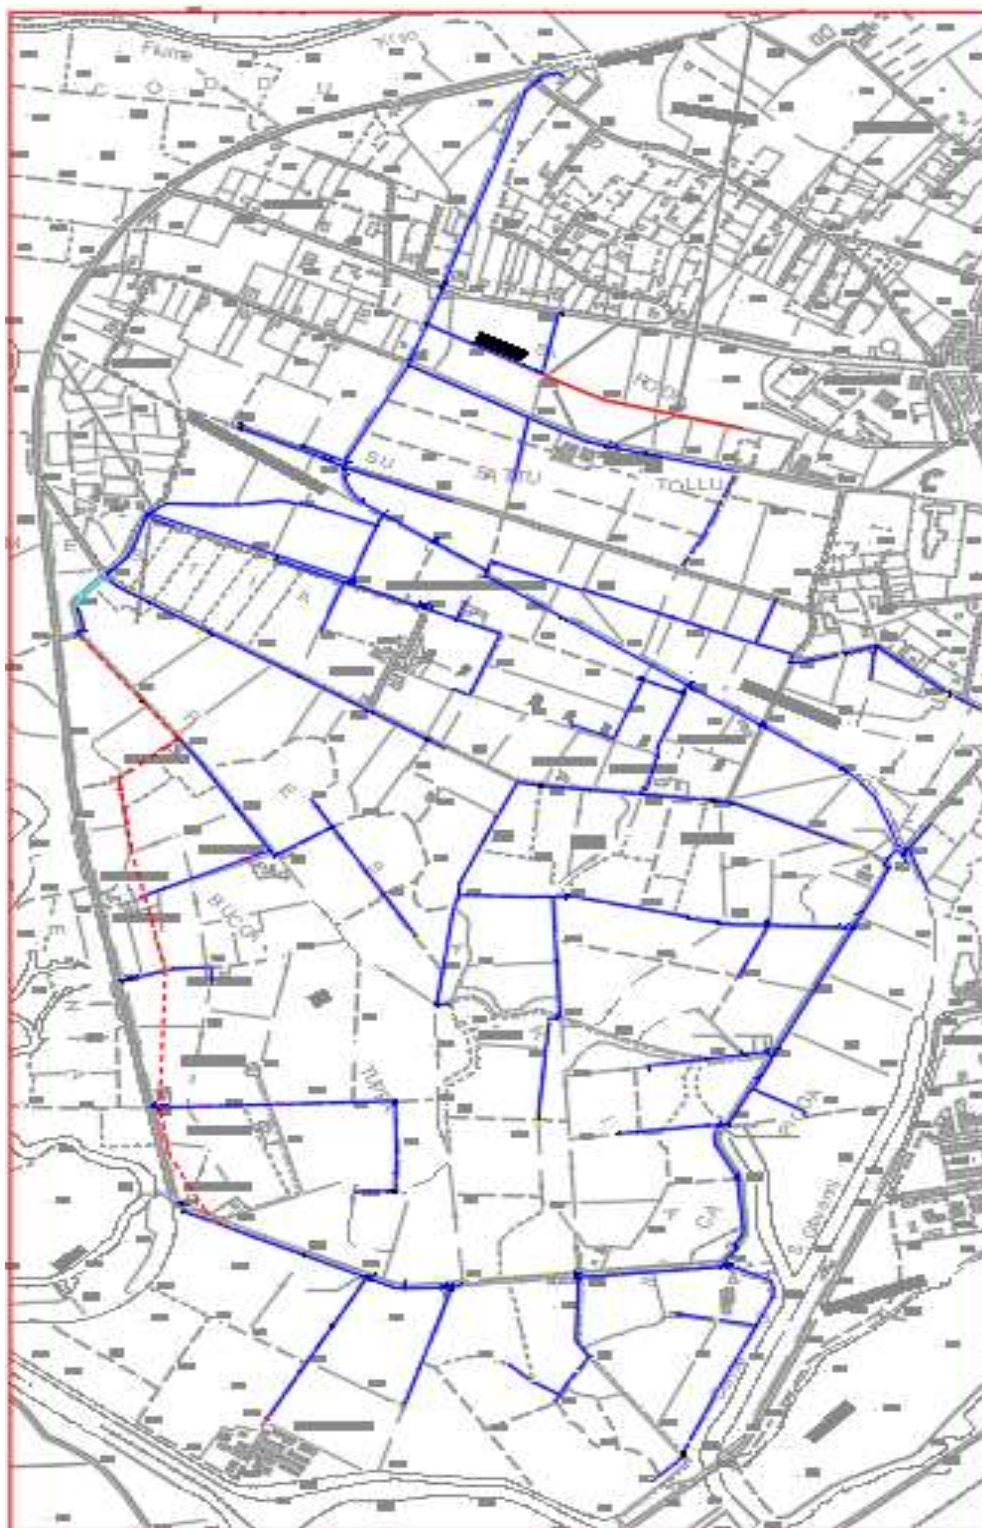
Planimetria del distretto irriguo con rappresentazione dello schema di distribuzione a canalette esistenti.
